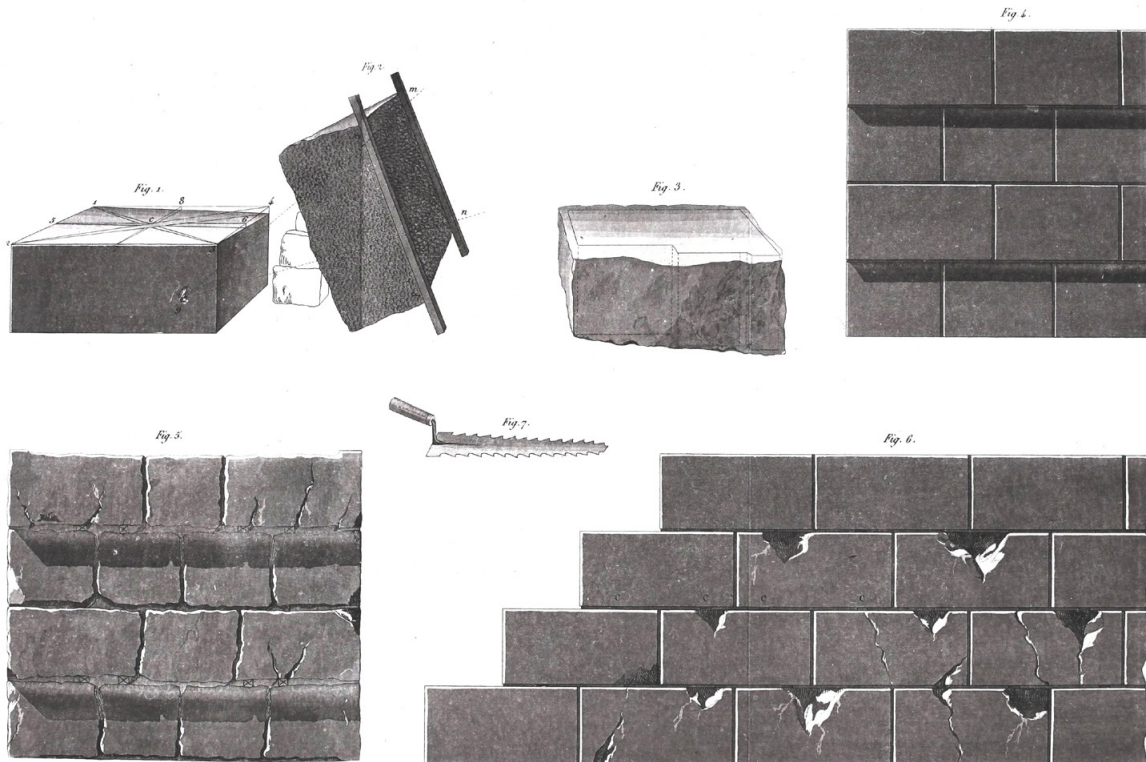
Daños en las piedras de los pilares del Panteón Francés por el mal corte de las piedras y el empleo de cuñas en la tirada exterior de las juntas (Rondelet 1804).
